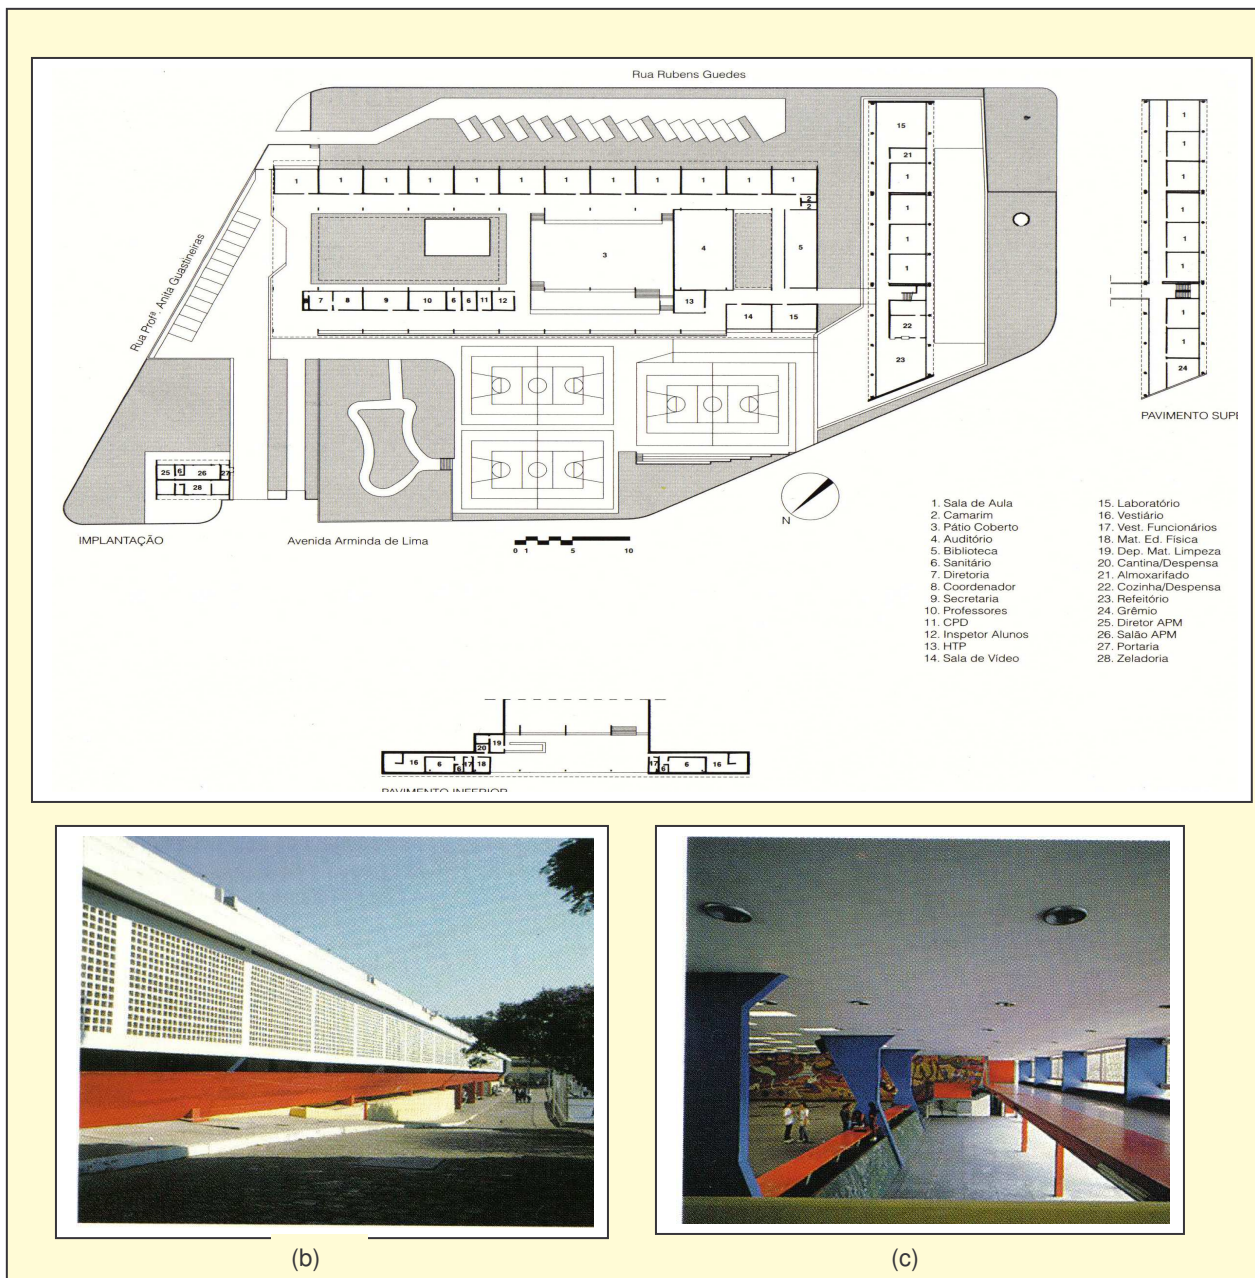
Escola de Guarulhos (1962), autoria de Vilanova Artigas e Carlos Cascaldi. Em (a): plantas baixas térreo, dos pavimentos superior e inferior; (b): vista da fachada; (c): vista do pátio interno.
